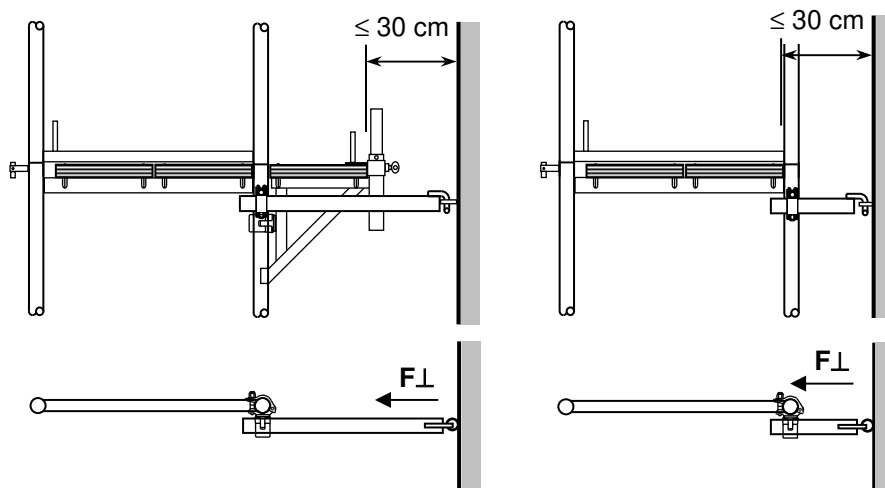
Höhenlage der Gerüsthalter bei Anschluss im „Knoten“
